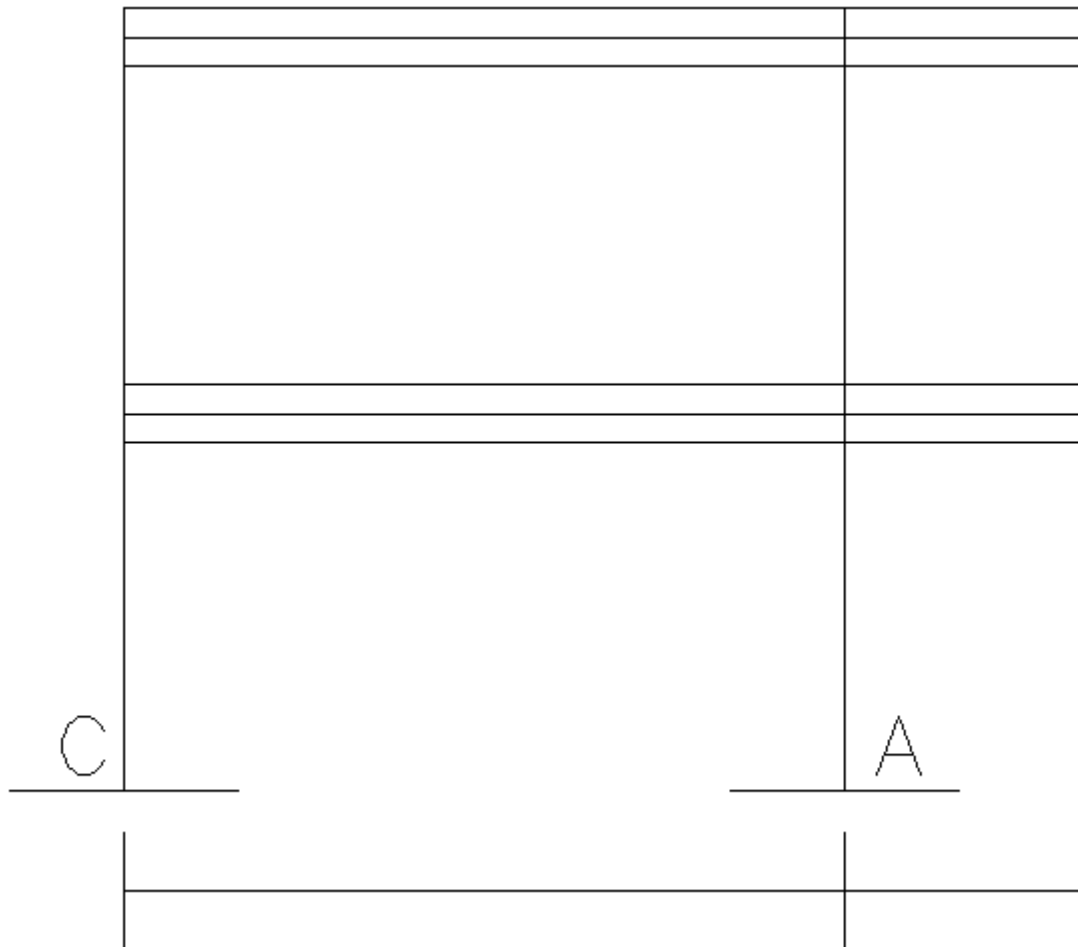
Cargas en viga del eje "2" primer piso y techo.
